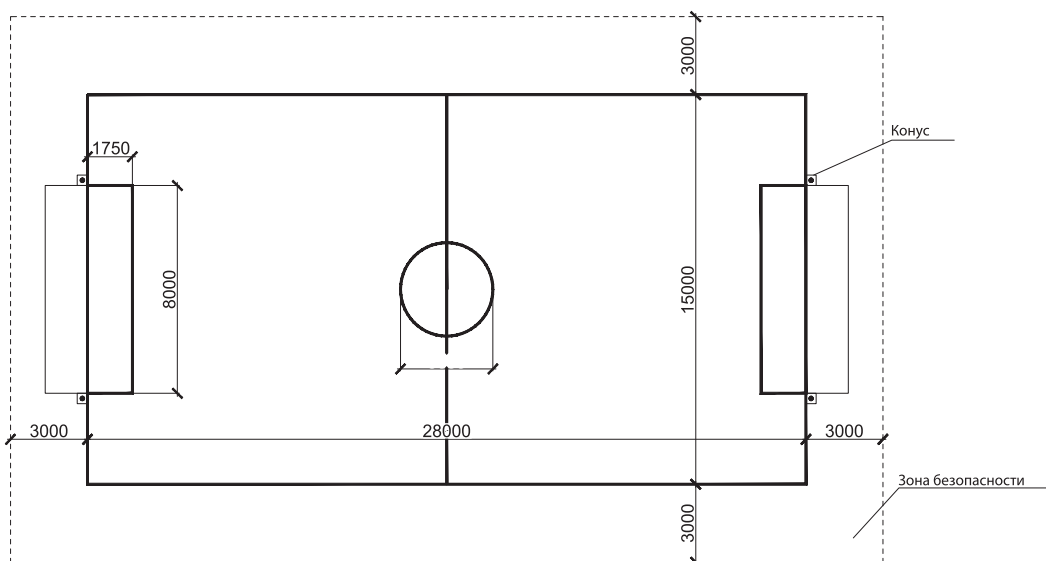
Схема соревновательной зоны с разметкой для регби на колясках
